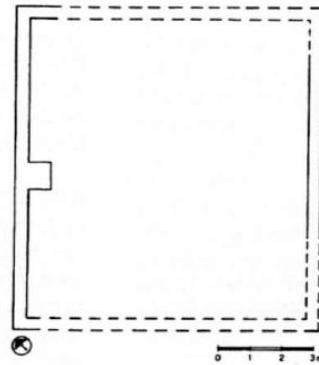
Grundstück Paternoster (1990): Schematischer Grundriss (ergänzte Mauersegmente strichliert).
